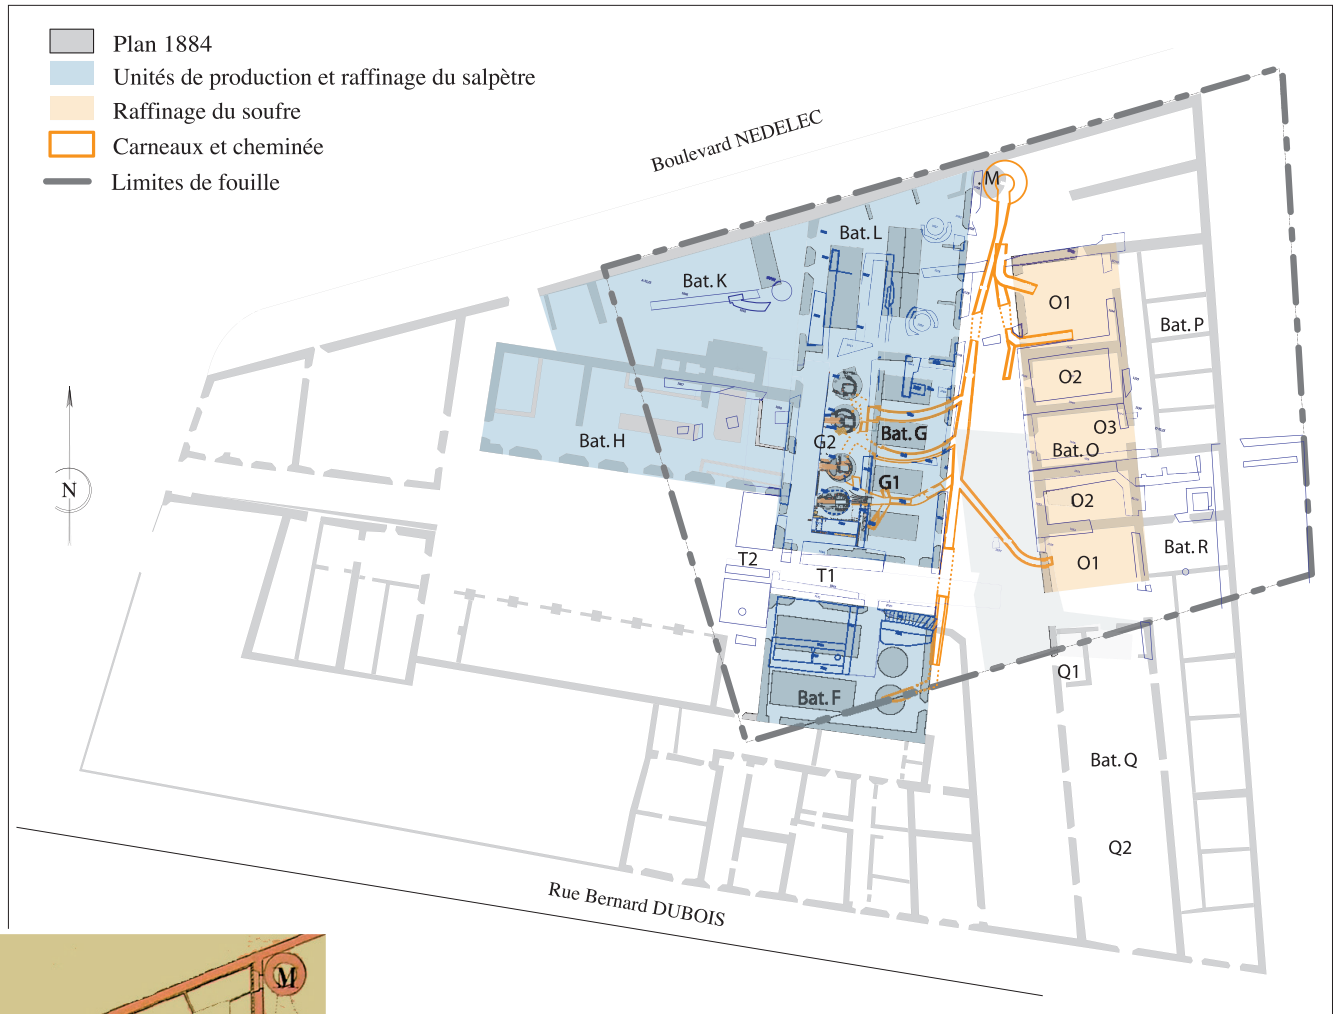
Extrait du plan de la raffinerie de Marseille de 1884 avec l'emprise de la fouille (DAO J. Collinet, Inrap).
